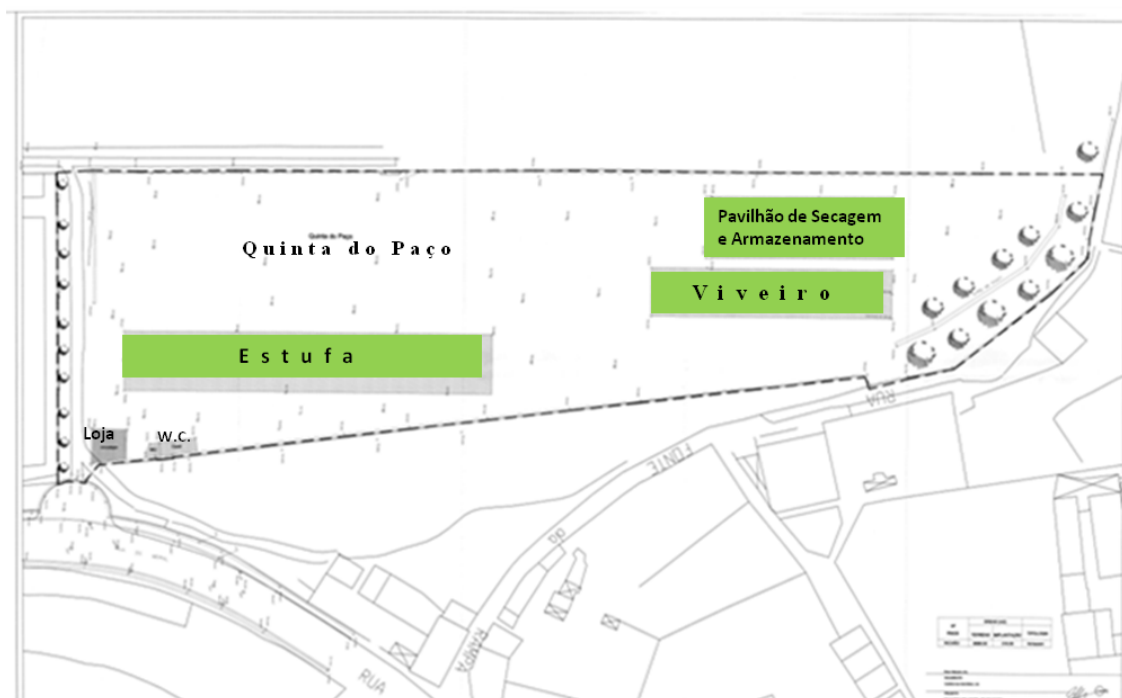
Planta da propriedade do Cantinho das Aromáticas, Janeiro 2010, Escala 1:200.
